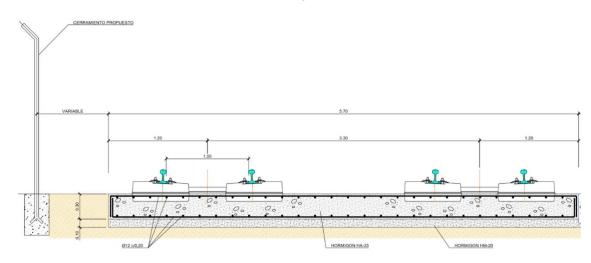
SECCION TIPO EN ANCHO METRICO
